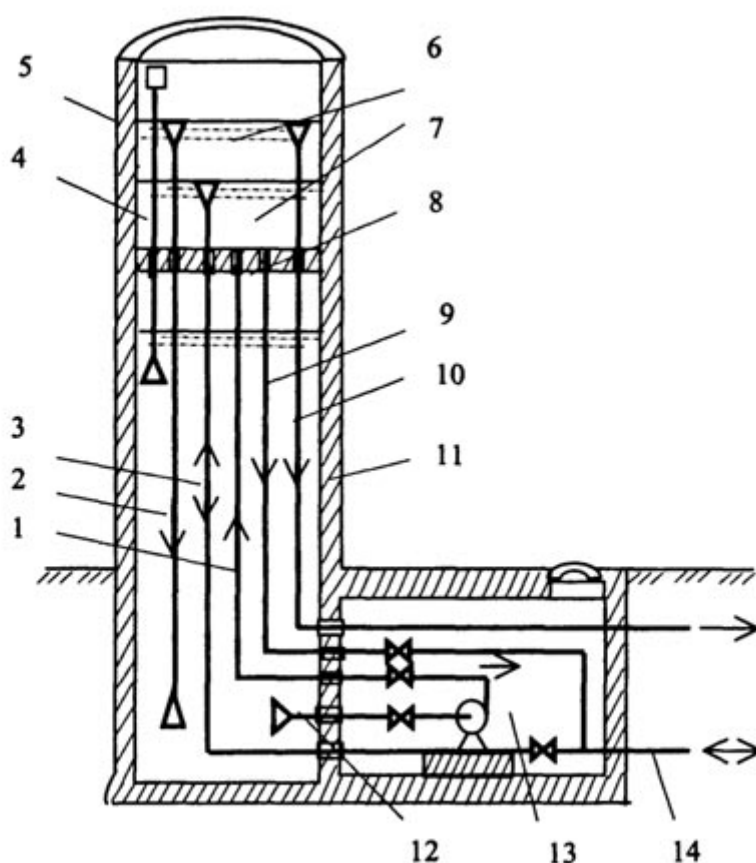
Схема оборудования водонапорной башни-колонны:
